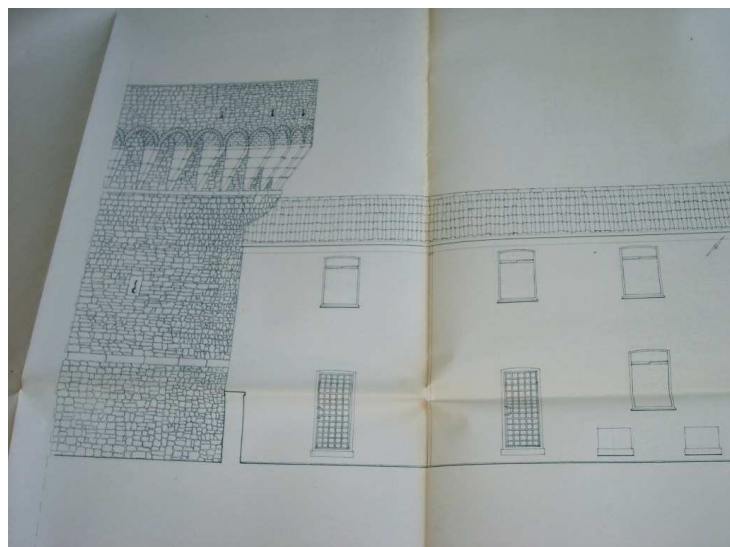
progetto SBAPL-1° cortile corpo nord-prospetto (stralcio)
